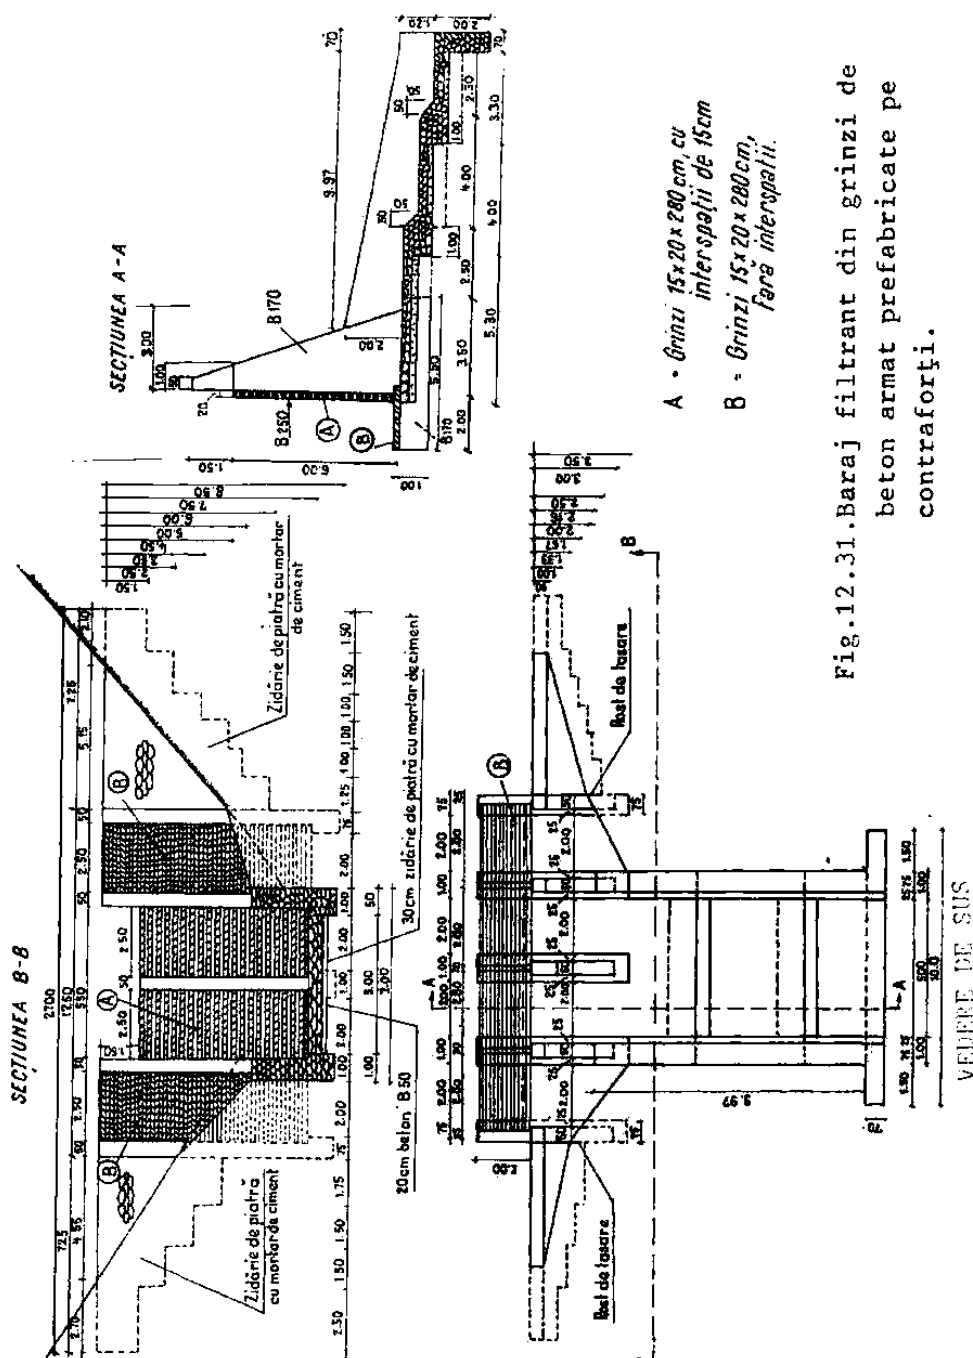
Baraj filtrant din grinzi de beton armat prefabricate pe contraforți.
